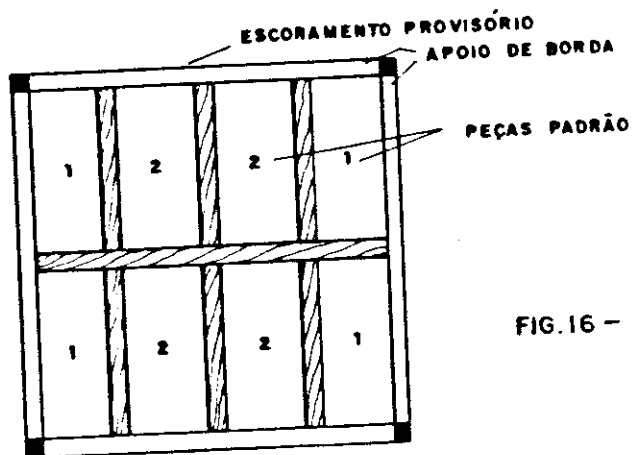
Vista em planta da cobertura com os escoramentos e as peças pré-moldadas
